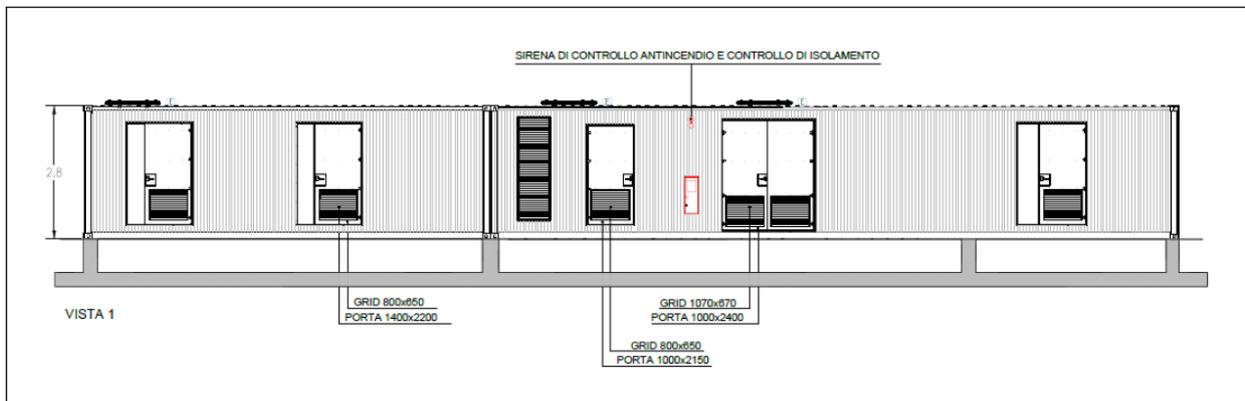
Cabina elettrica e di smistamento – Prospetto
